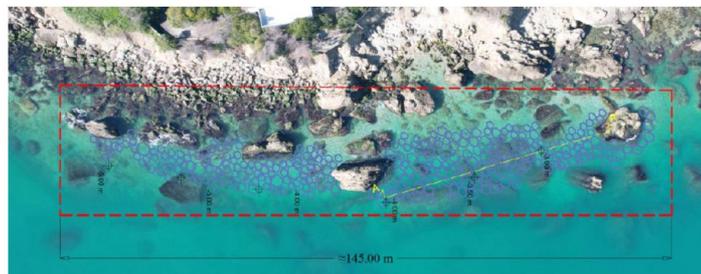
Planimetria tipo di progetto (fonte Relazione generale del progetto)
